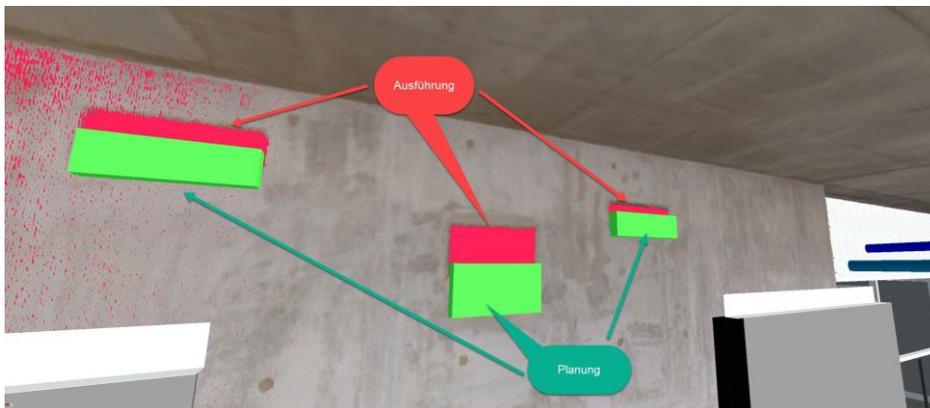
Beispiele einer Abweichung zwischen Planung und Ist-Zustand der Baustelle
